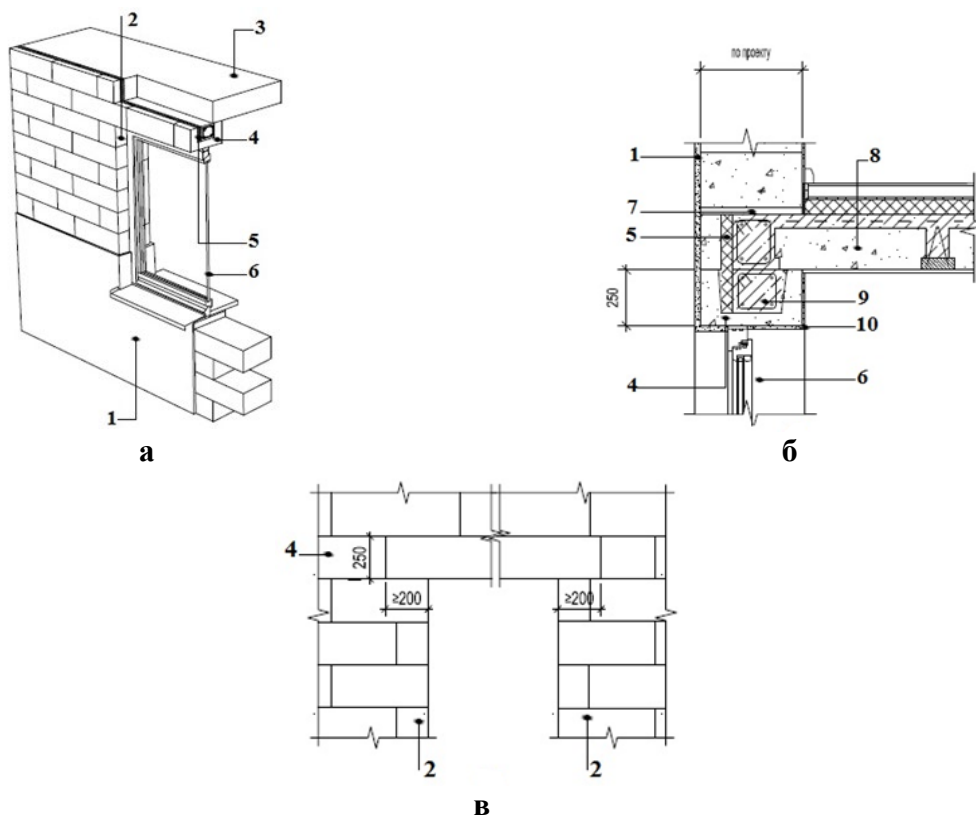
Наружная несущая стена из блоков: а — элемент конструкции; б — разрез по стене; в — разрез по оконному проёму; 1 — наружная стена; 2 — блоки YTONG; 3 — перекрытие; 4 — U-образный блок YTONG; 5 — минеральная вата; 6 — оконный блок; 7 — шов из цементного раствора; 8 — сборное монолитное перекрытие; 9 — монолитный железобетонный пояс; 10 — внутренняя отделка
